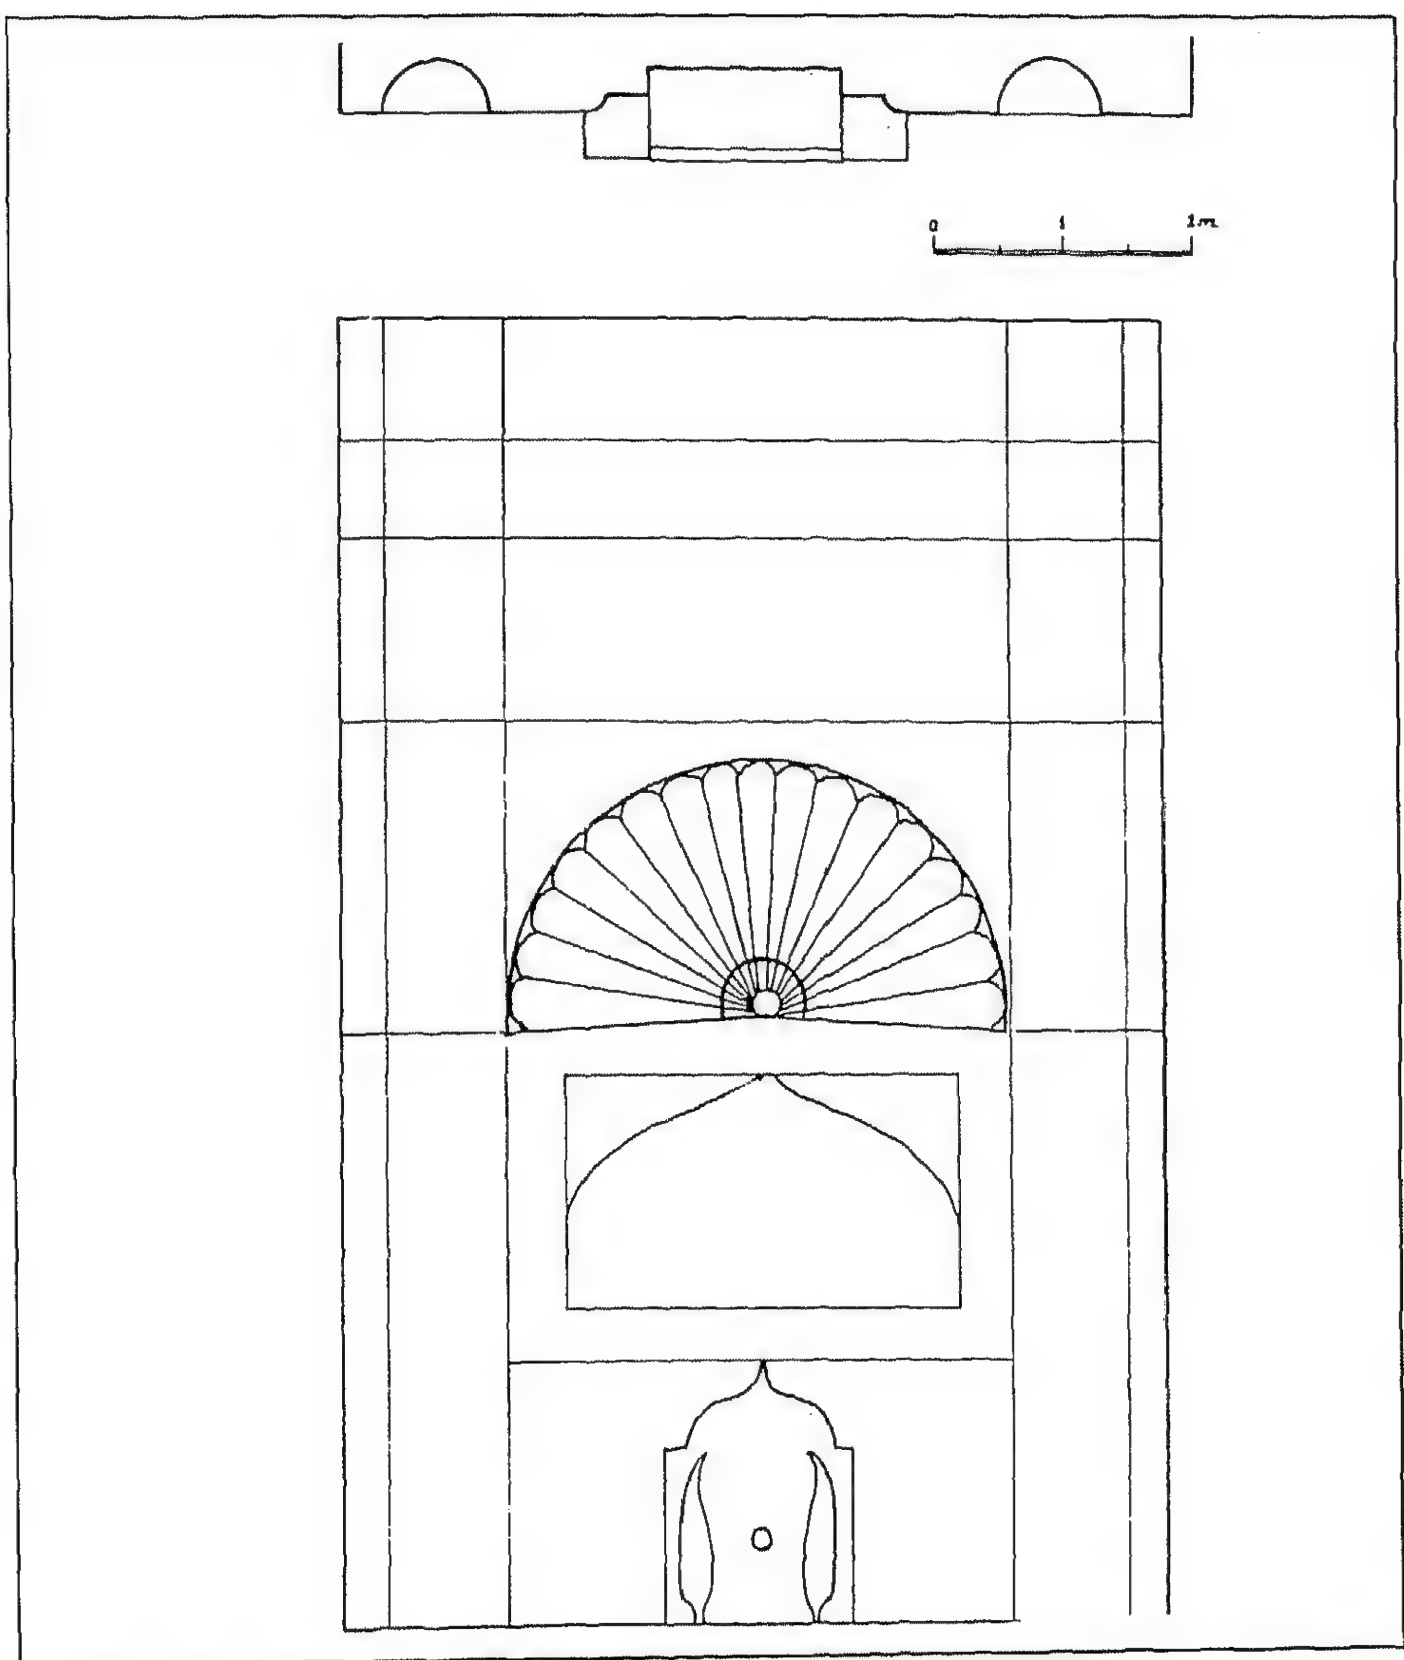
مسقط أفقي لچشمه حسين باشا في أدرنة (عن: ÖNGE).
